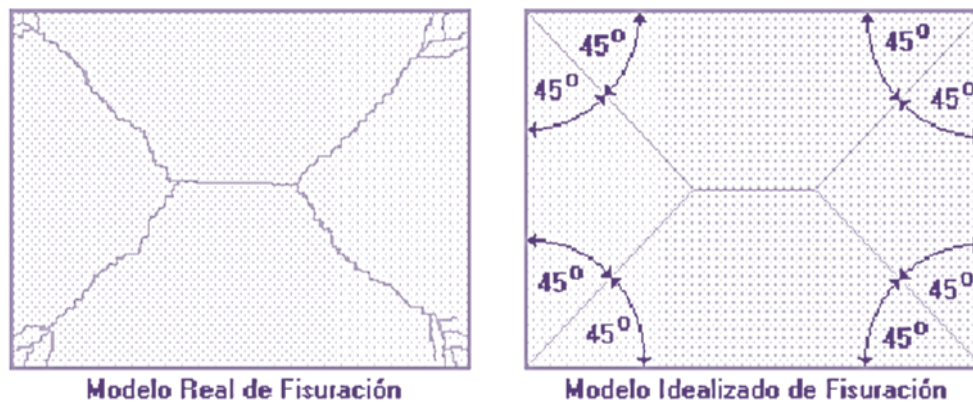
Fisuración según Teoría de Líneas de Rotura
